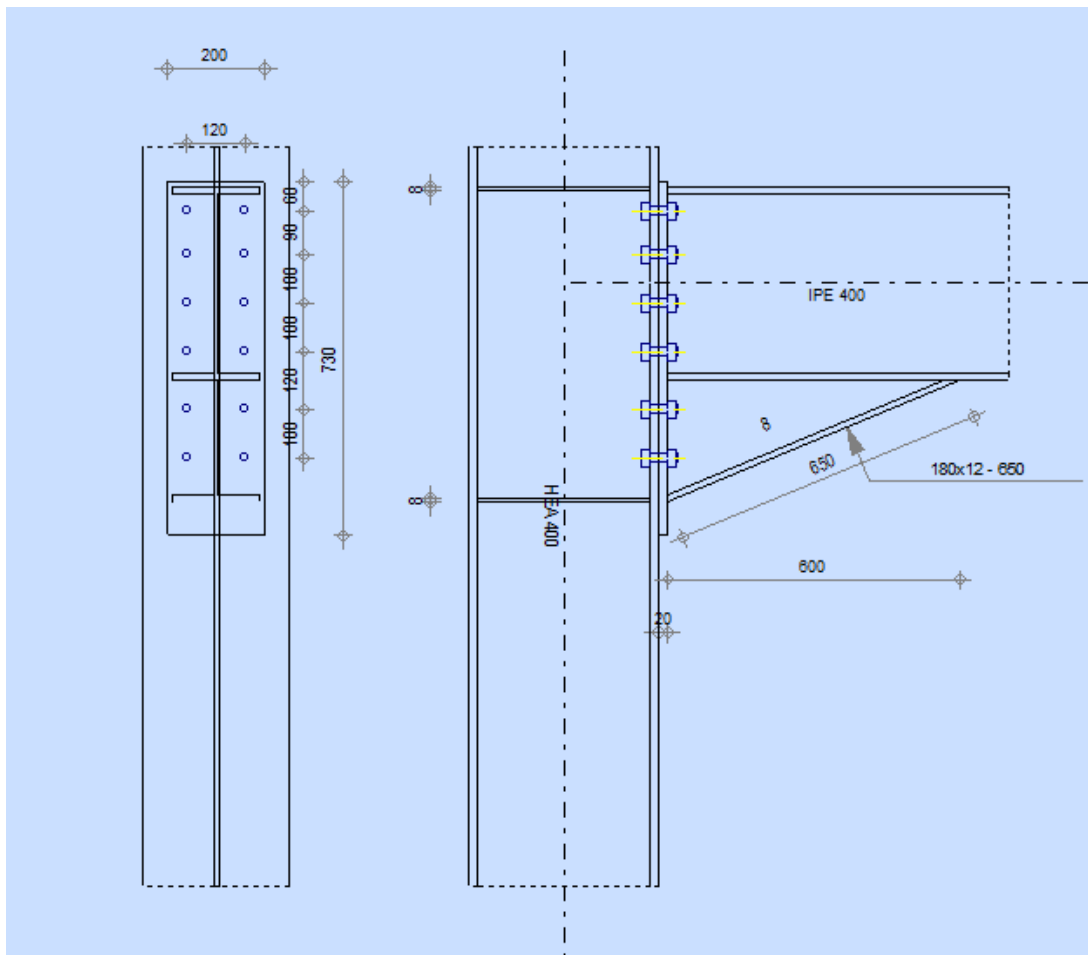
Schéma d'assemblage poteau – poutre.
